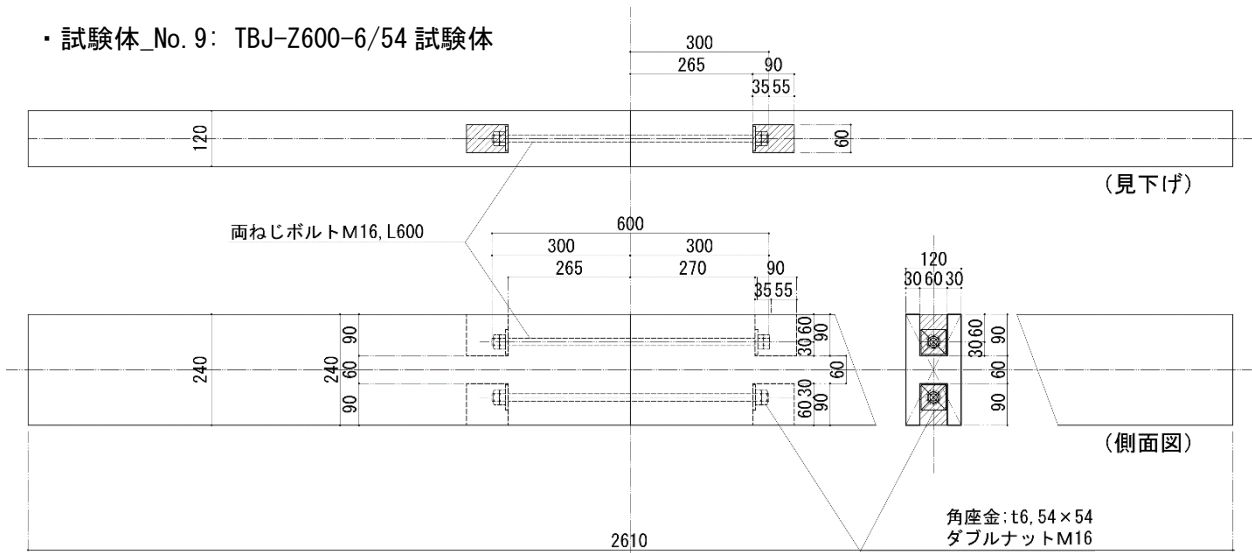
試験体\_No. 9: TBJ-Z600-6/54 試験体
